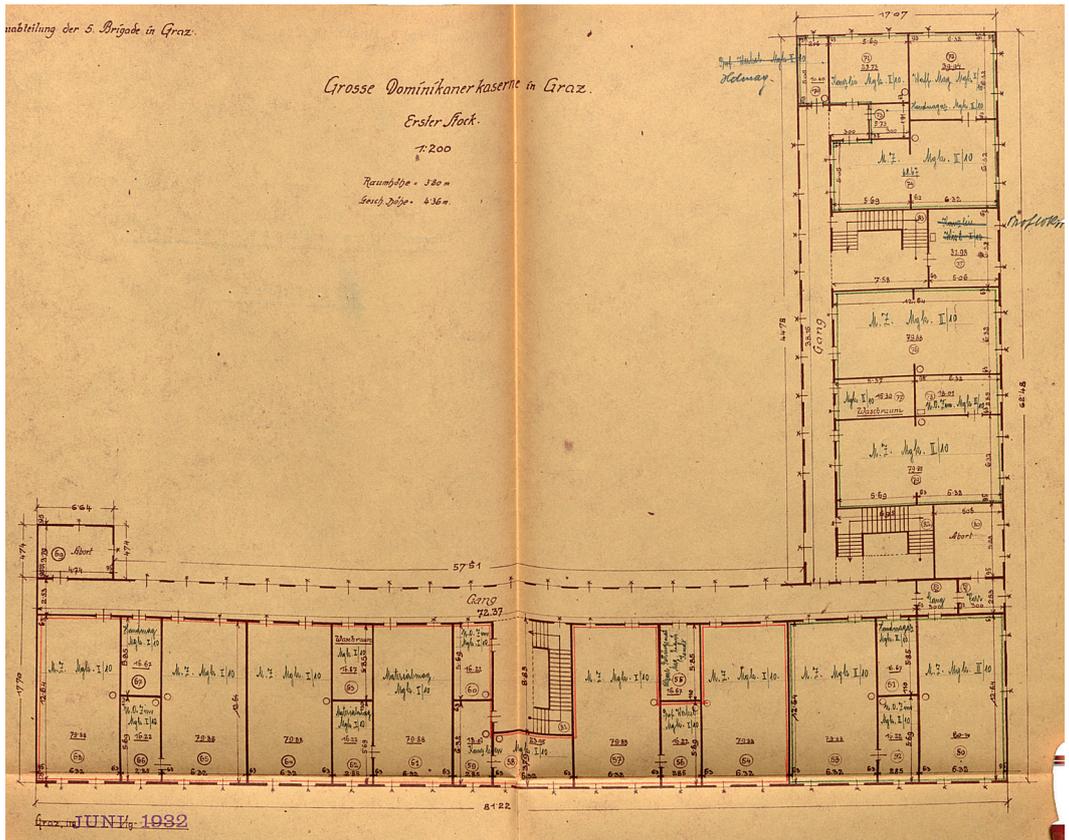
Grundrisse aus dem Jahr 1932
